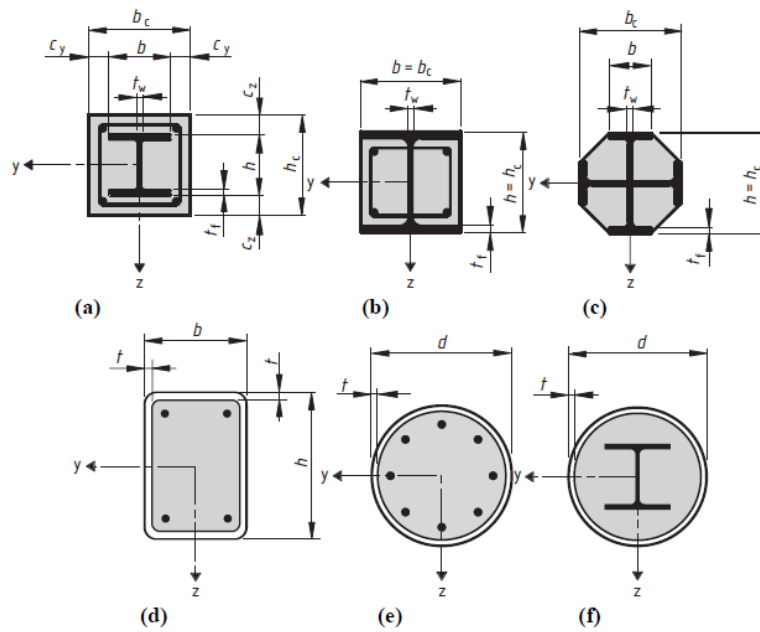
Secciones de pilares mixtos (EC4, 2004).
